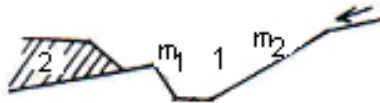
Конструктивная схема поперечного сечения нагорного канала:
